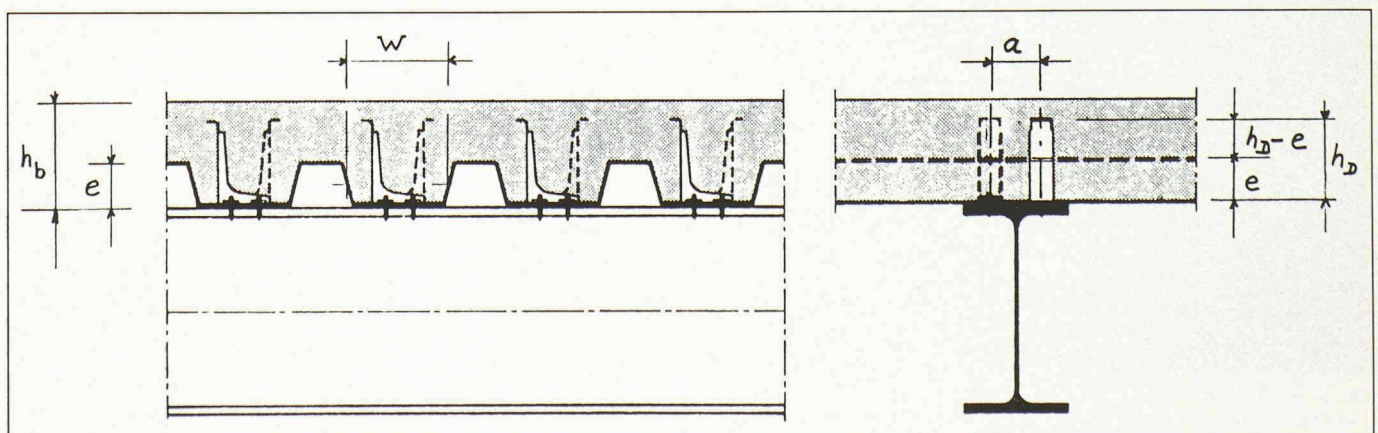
Poutre mixte acier-béton avec tôle profilée et deux rangées de connecteurs *HVB* disposés en sens opposé.
